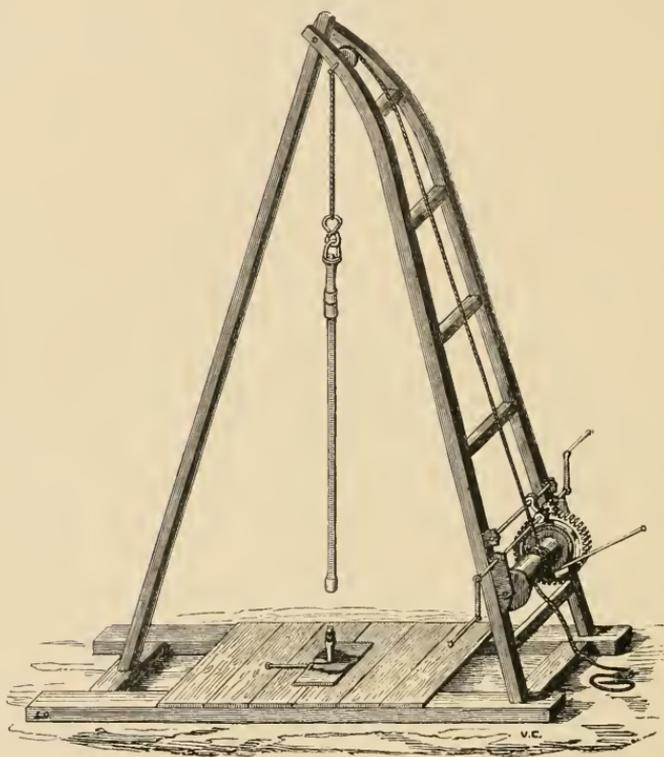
Chèvre pourvue d'un treuil à engrenages.
